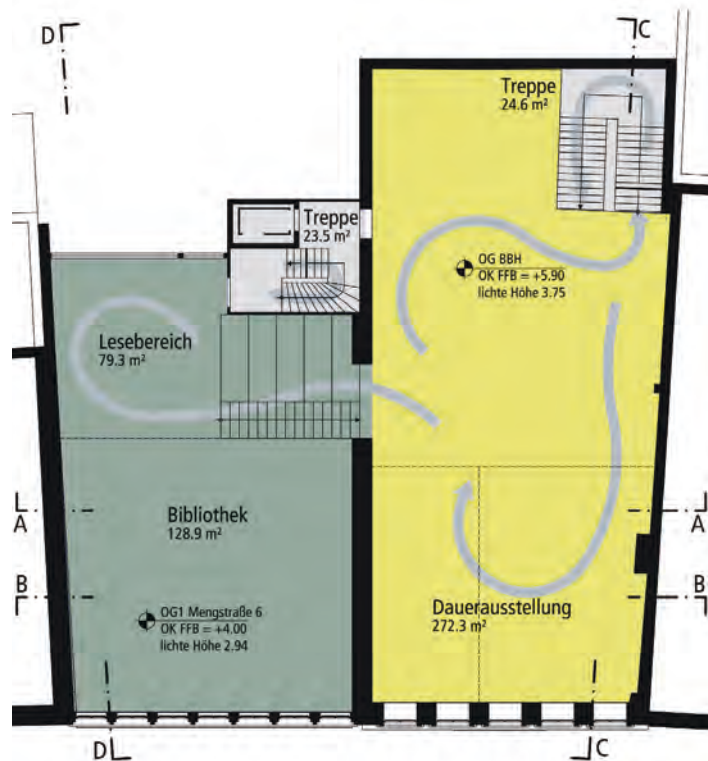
Variante 2, Grundriss Obergeschoss 1
